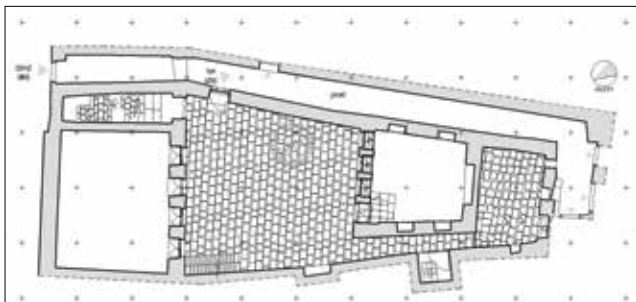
Yapının ilk dönemi plan şeması önerisi (Restitüsyon projesinden üretilmiştir, 2018). / First phase plan scheme proposal of the building.
